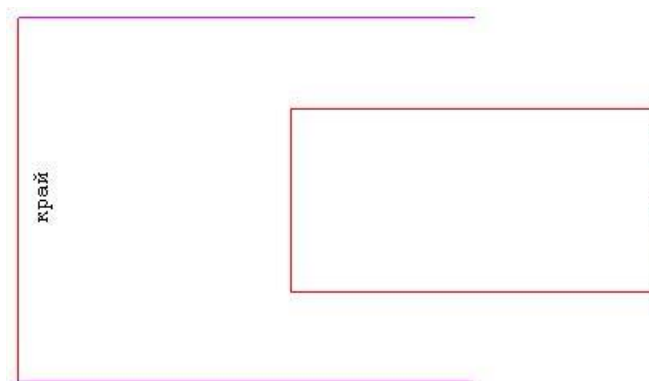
Расчетный контур при продавливании краем стены с учетом края плиты
